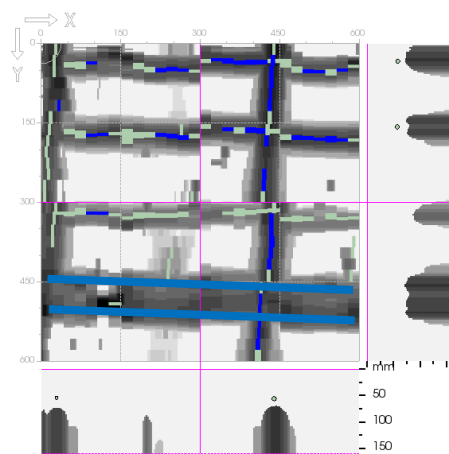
Poutre Pt01 – Travée 3 à mi-travée
